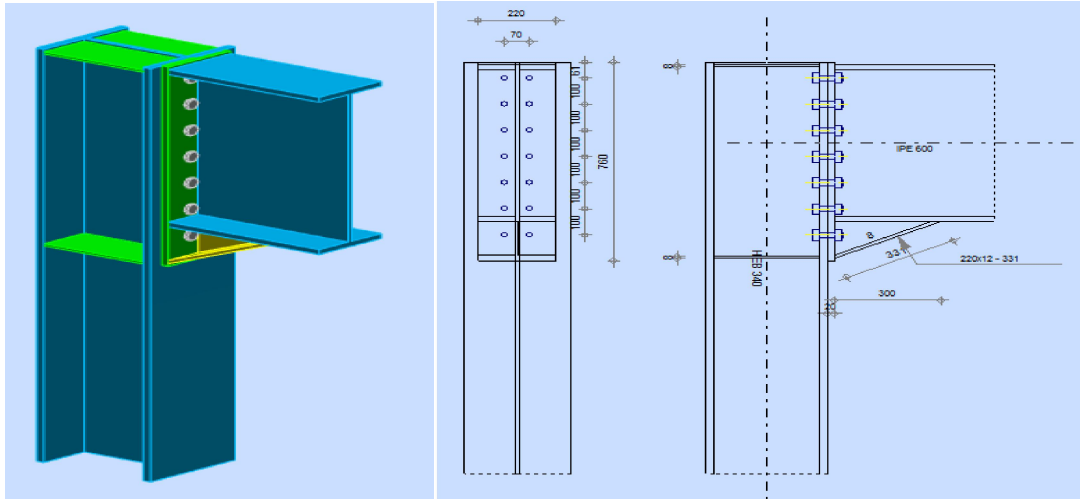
Assemblage poteauHEB340 – poutreIPE600
